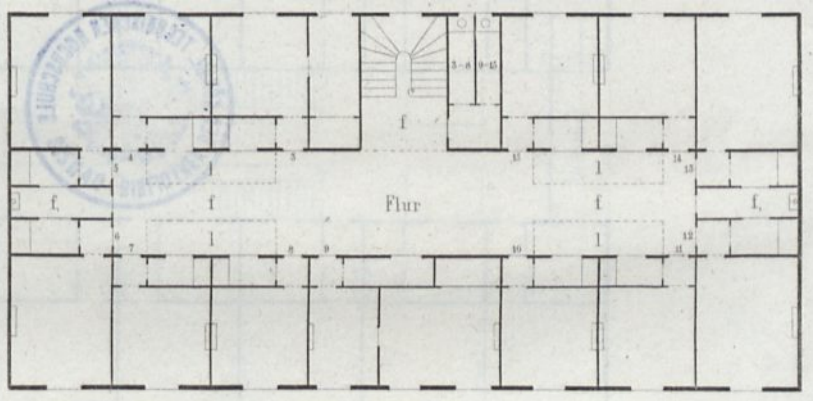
Grundriss von A, (Parterre Etage)
